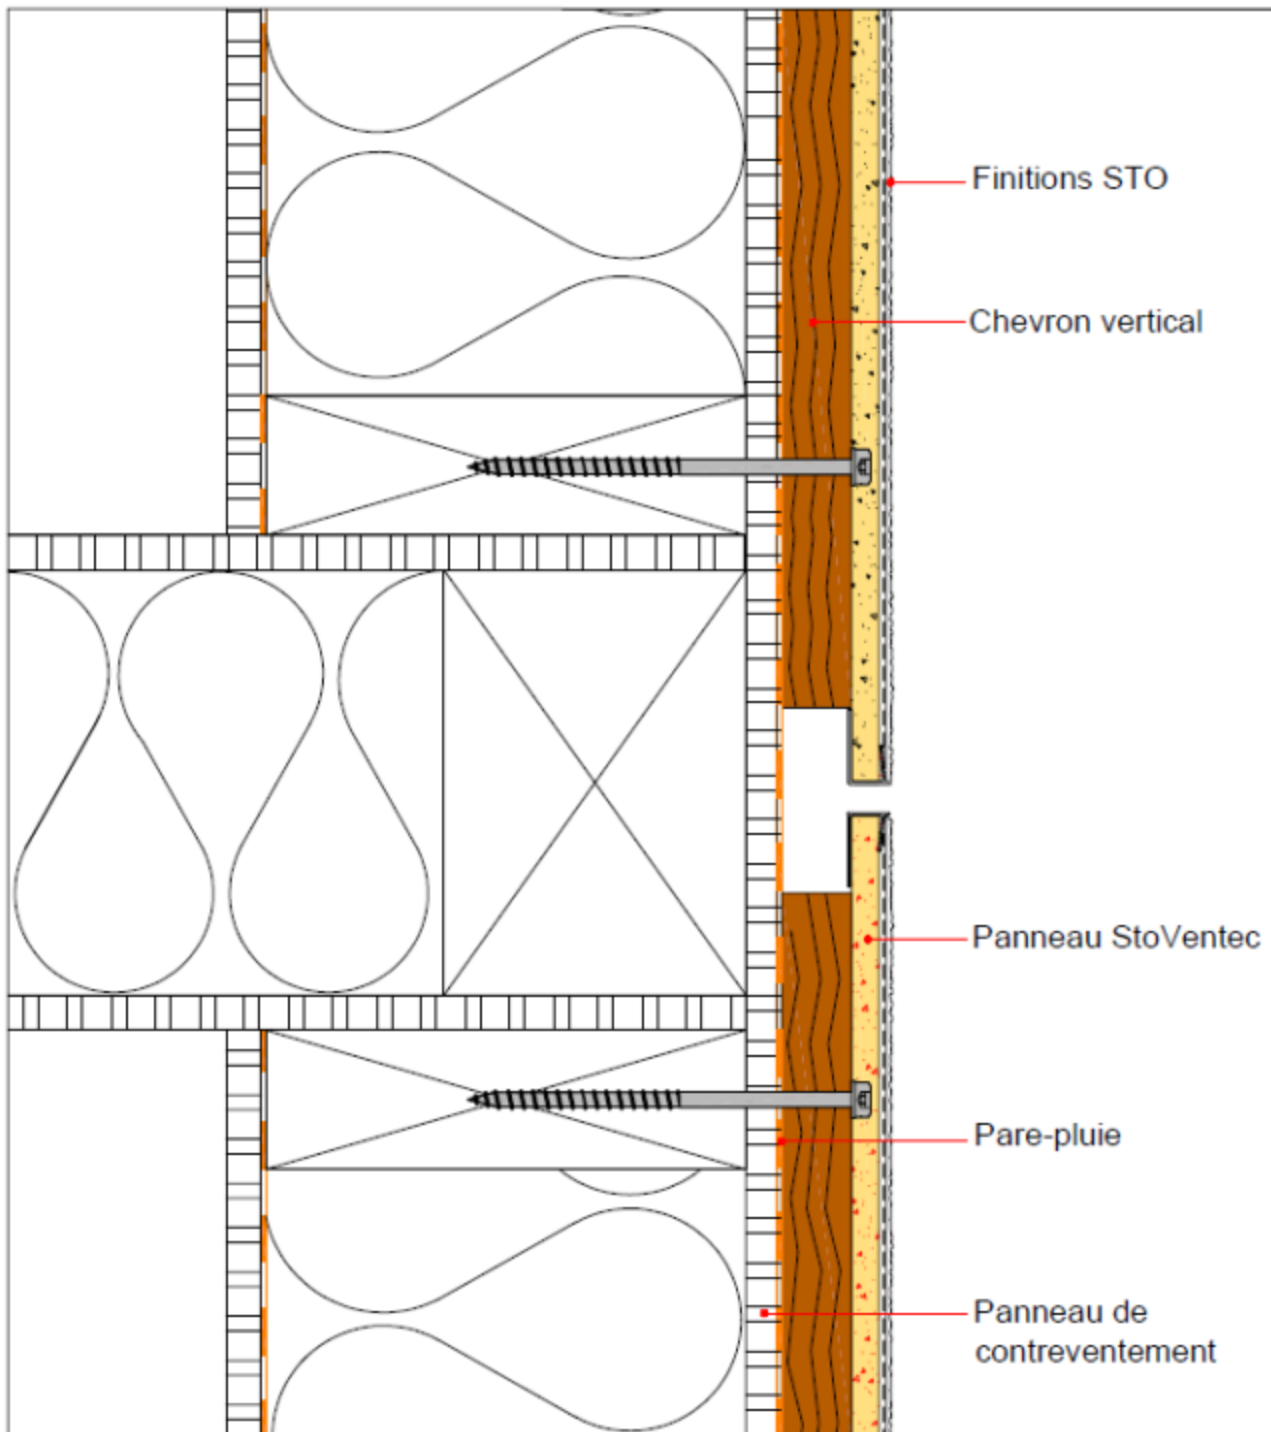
Coupe verticale - Fractionnement à joint ouvert au droit d'un plancher en situation $a, b, c, d < 6$ m et en situation $a, b, c < 10$ m - Ossatures bois sur COB
